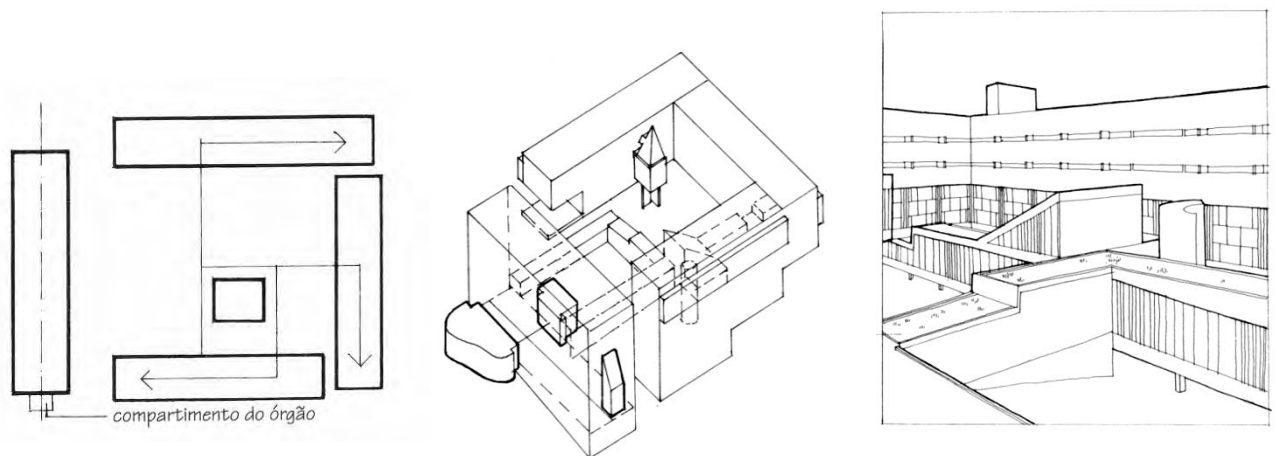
A adição de caminhos e outros elementos que preenchem o claustro, Convento de La Tourette, França.
